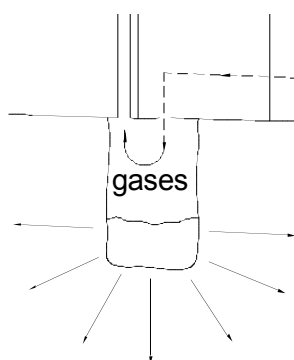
LETRINA SIMPLE CON VENTILACIÓN
